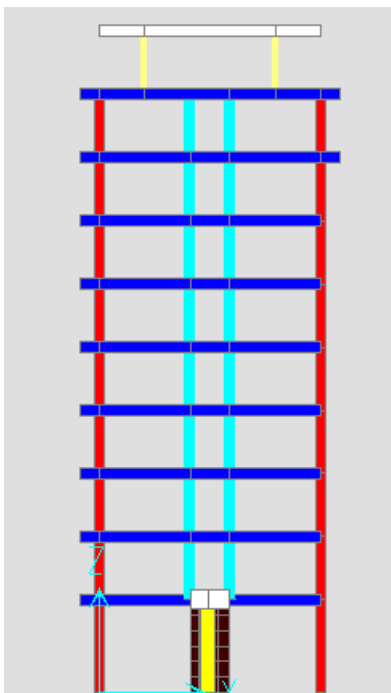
Voile de 35cm en RDC plan y-z.
